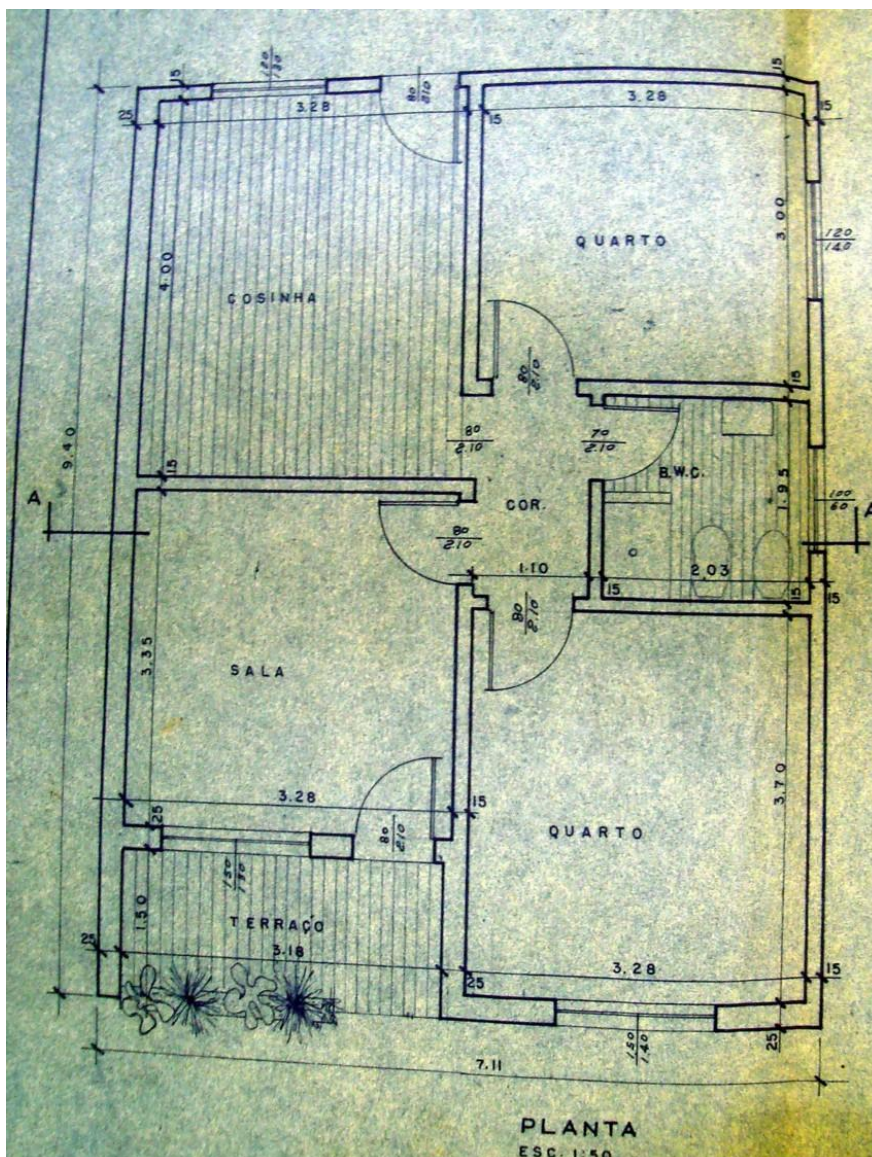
Projeto Arquitetônico / Planta baixa (Residência da Travessa Barroso)
